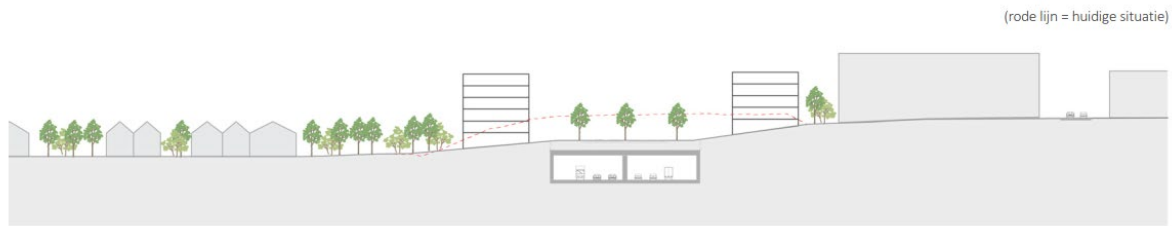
Coupe d'un éventuel pont paysager à la hauteur de Wemmel-Jette
